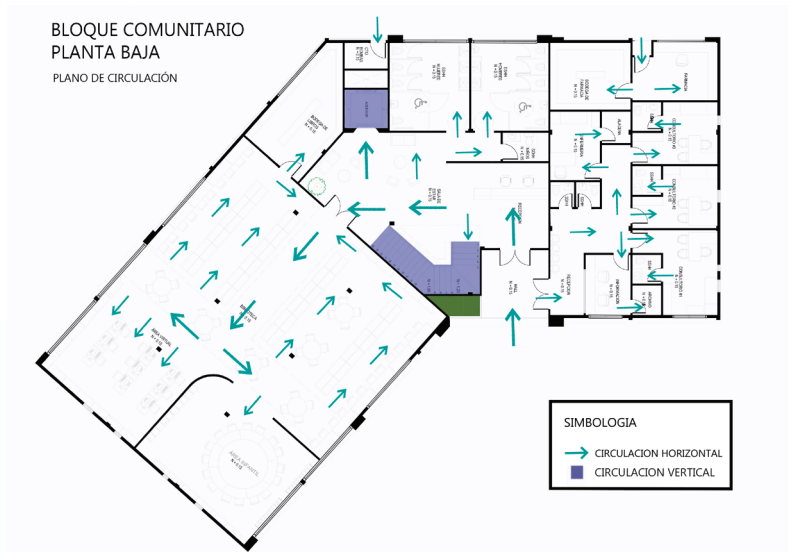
Planta arquitectónica Bloque comunitario - Planta Baja. Fuente: Elaboración Propia.
